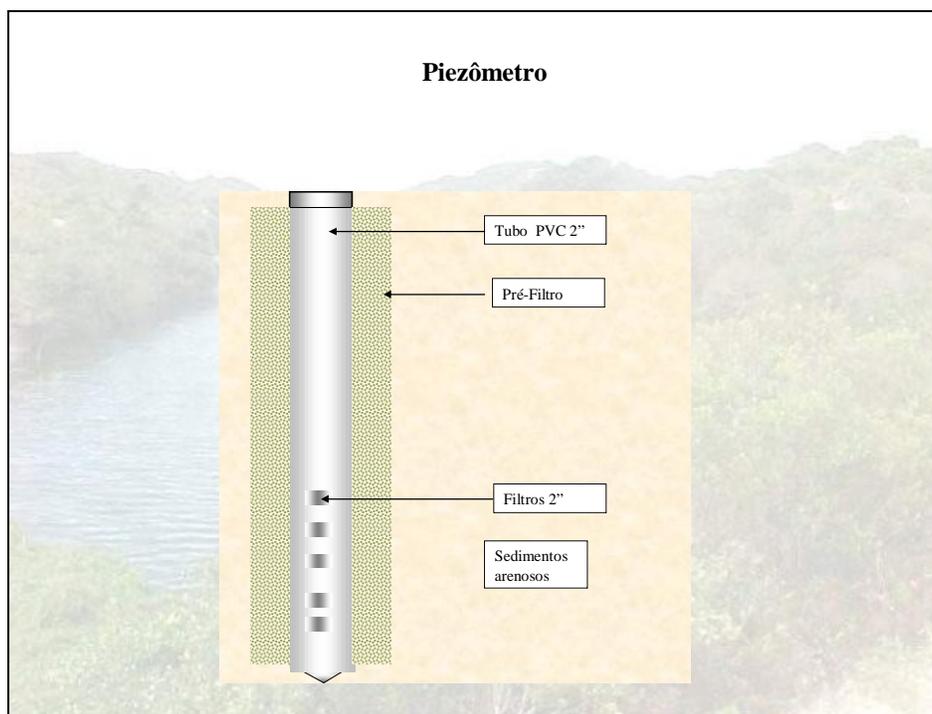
Perfil construtivo esquemático dos piezômetros, sem escala.
